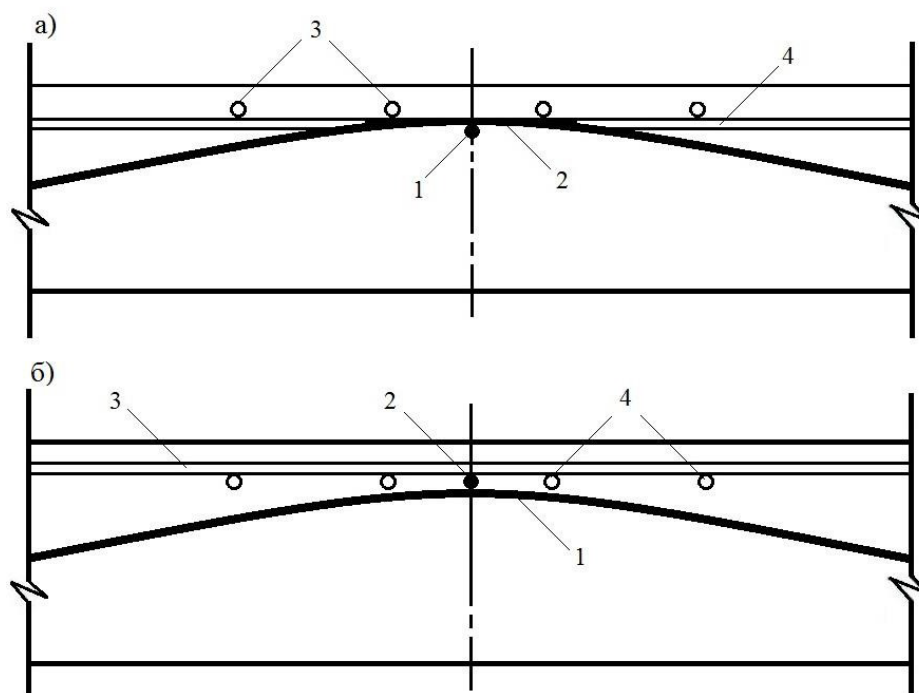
Взаємне розташування напружених елементів і ненапруженої арматури при армуванні плит перекриттів у двох напрямках: *а* - в поздовжньому напрямку; *б* - в поперечному напрямку; 1 - напружені елементи поздовжнього напрямку; 2 - напружені елементи поперечного напрямку, 3 - ненапружена арматура поздовжнього напрямку, 4 - ненапружена арматура поперечного напрямку
